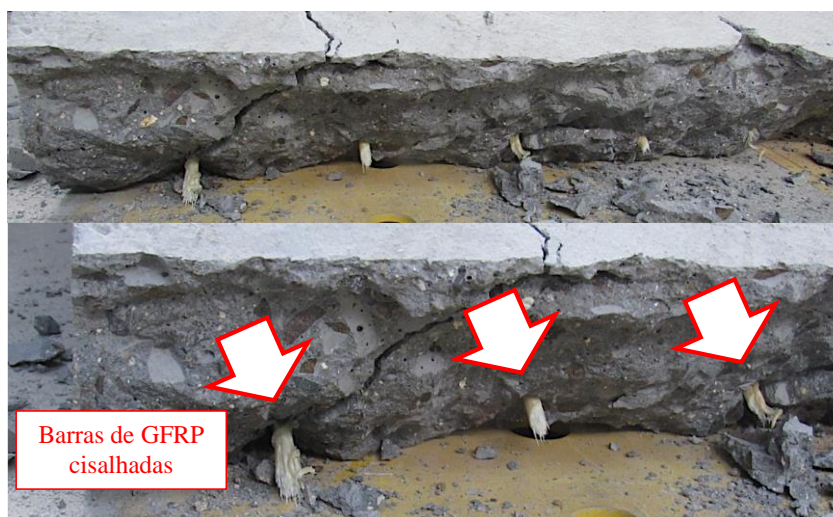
Aspecto visual de la armadura de PRFV tras un fallo de cortante interno causado por la propagación de grietas en la losa
